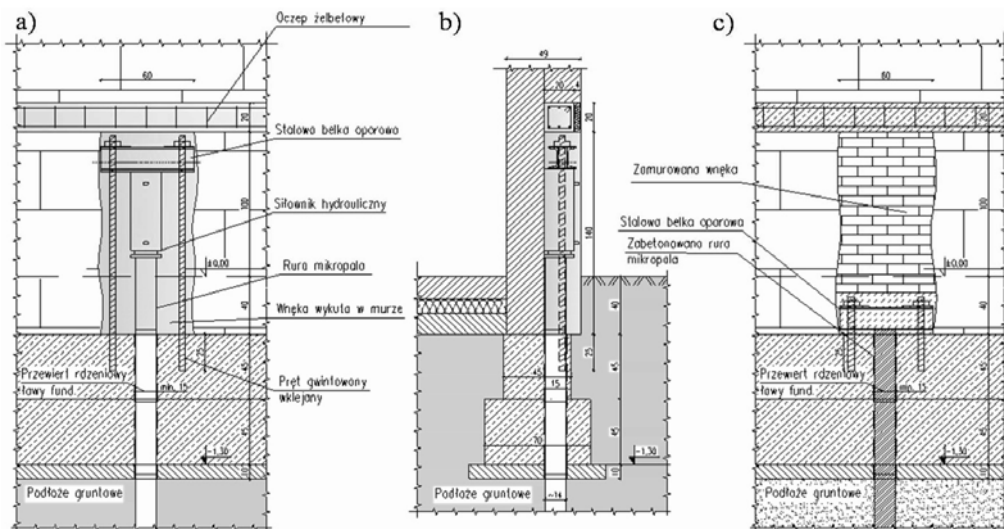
Схема усиления фундаментов: а) схема выполнения усиления фундаментной ленты; б) разрез по фундаментной ленте; в) фронтальный вид фундаментной ленты после получения усиления.
